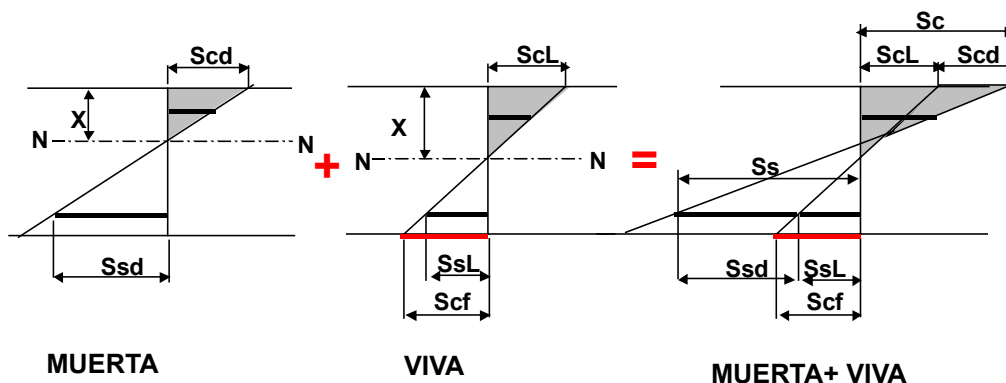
Esfuerzo debido a la Carga muerta y la carga viva
